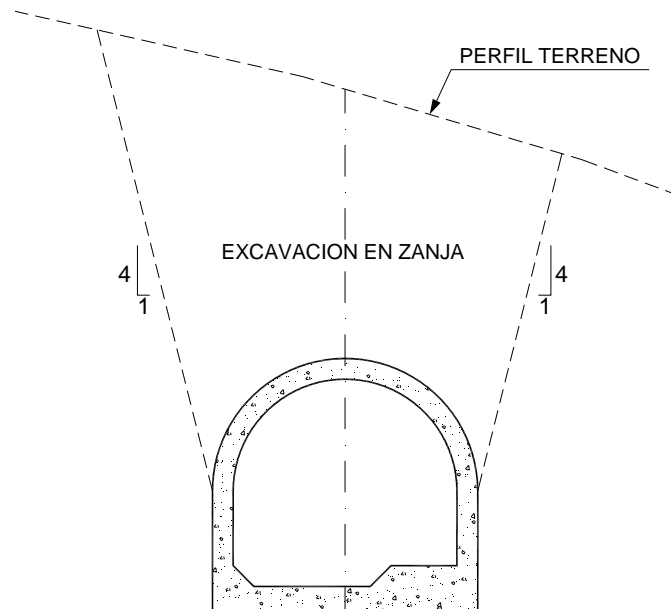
ESQUEMA EXCAVACION EN ZANJA
